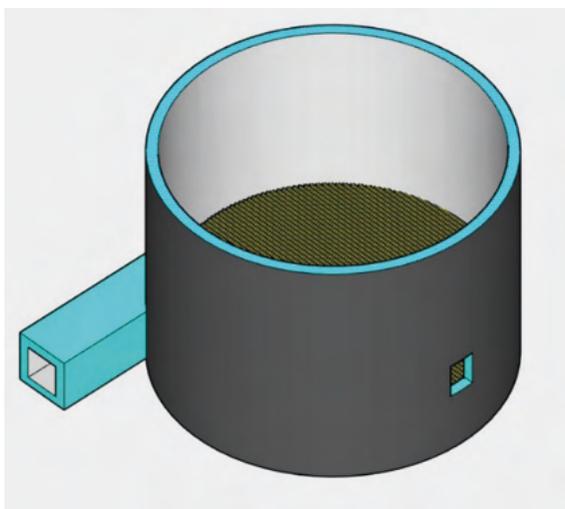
Detalhes construtivos do silo secador em alvenaria após o reboco.
